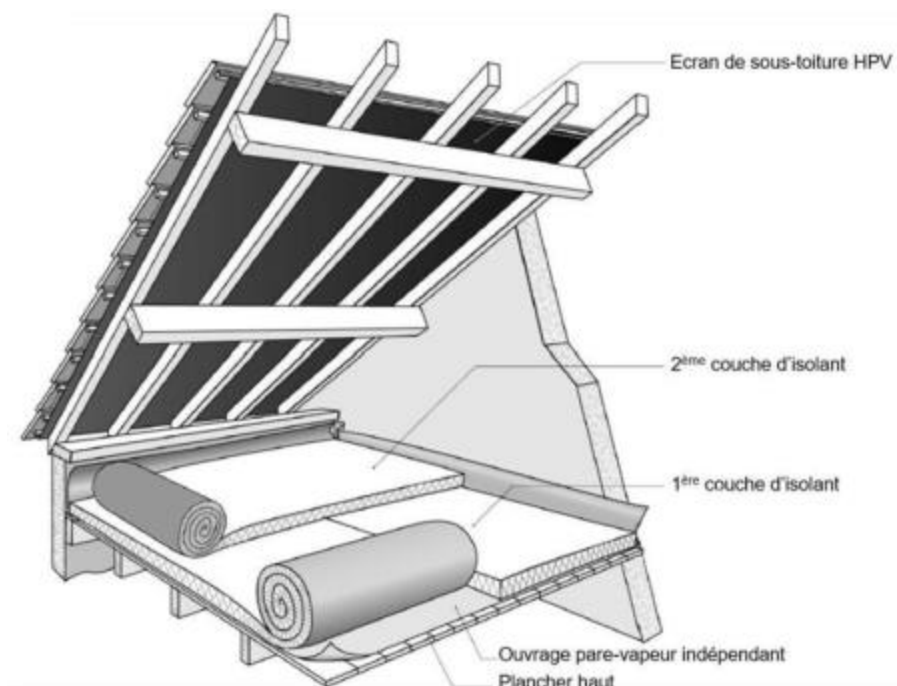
Mise en œuvre en deux couches sur plancher bois
